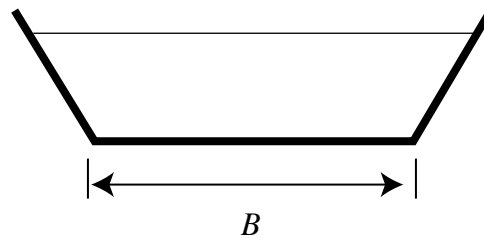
Canale di sezione trapezoidale con sponde inclinate di 45° gradi.
